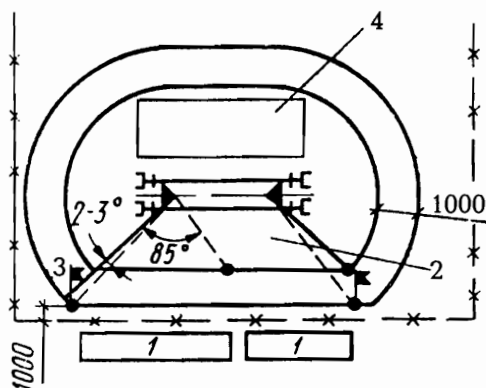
Ограничение угла поворота стрелы крана при работе в стесненных условиях строительной площадки: 1 – жилые здания; 2 – зона ограничения; 3 – ориентир ограничения на местности; 4 – монтируемое здание
